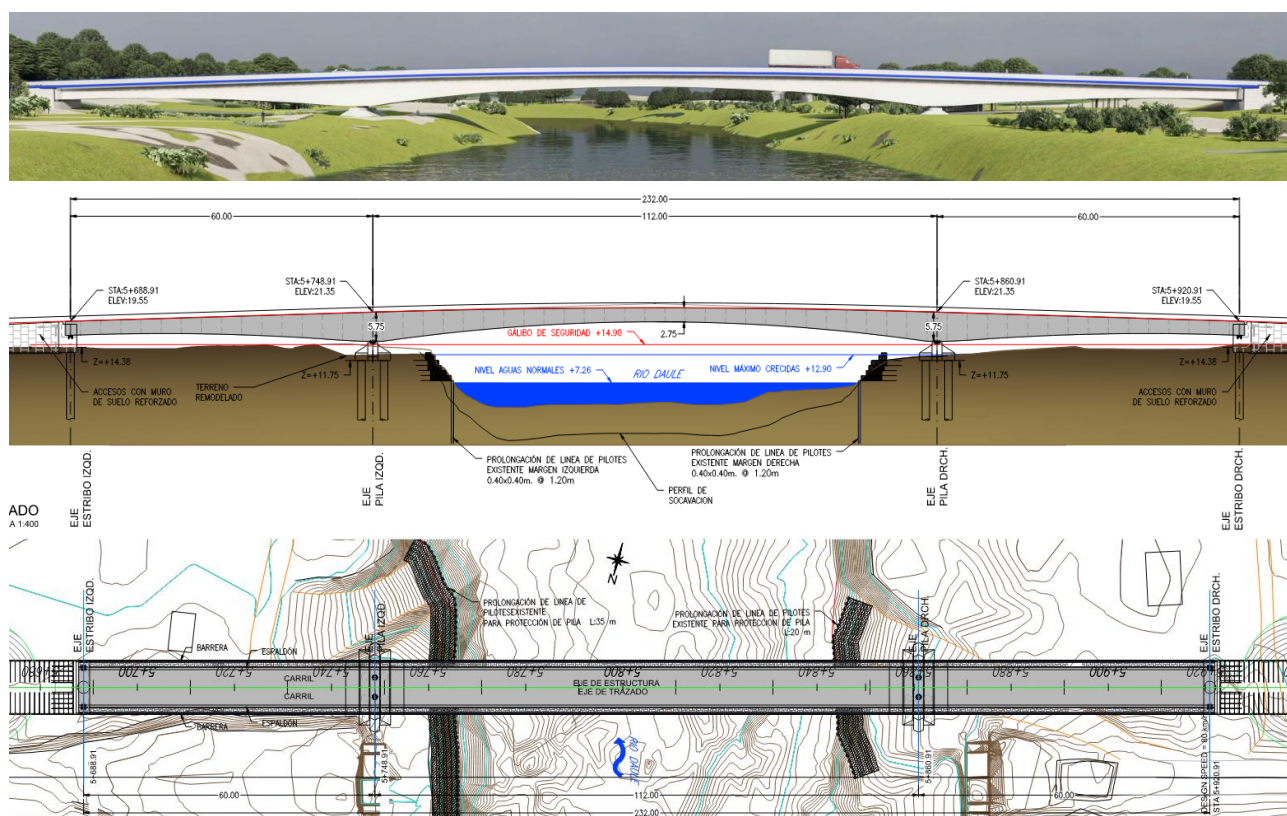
Elevación longitudinal y planta general del Puente Colimes.
